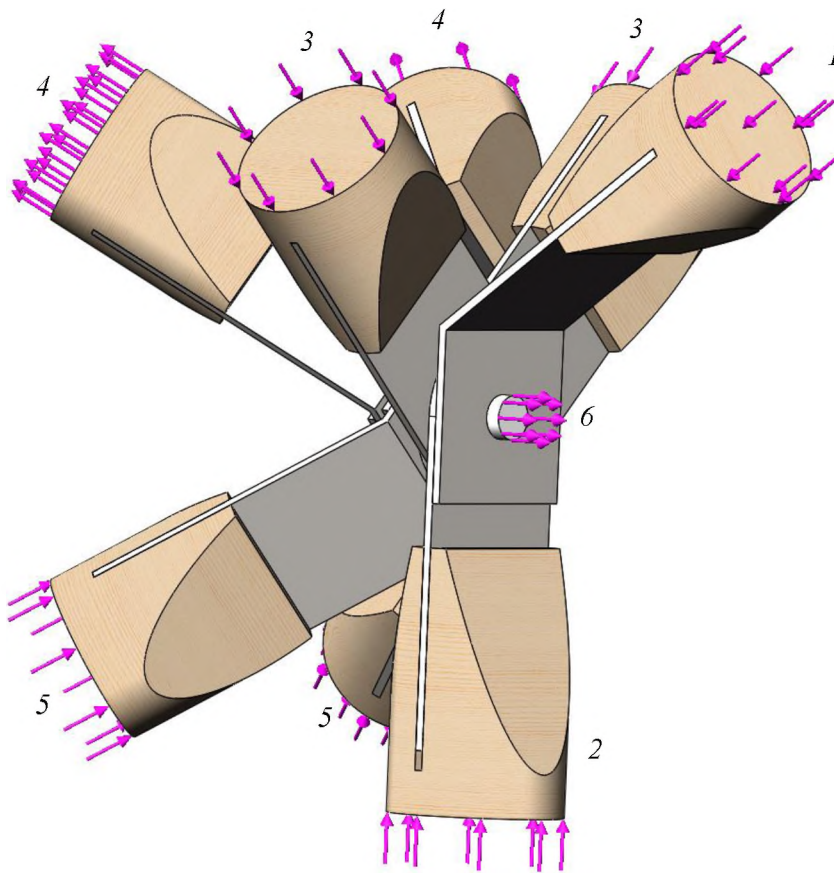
Расчетная схема наиболее нагруженного узла конструкции:
